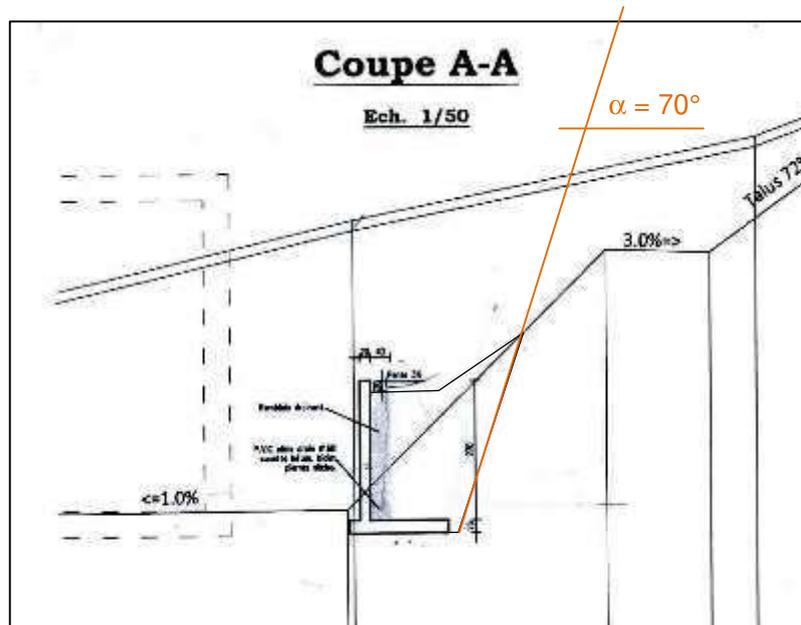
Coupe A-A plan MS-01 DCE Ind.0 25/05/2020
